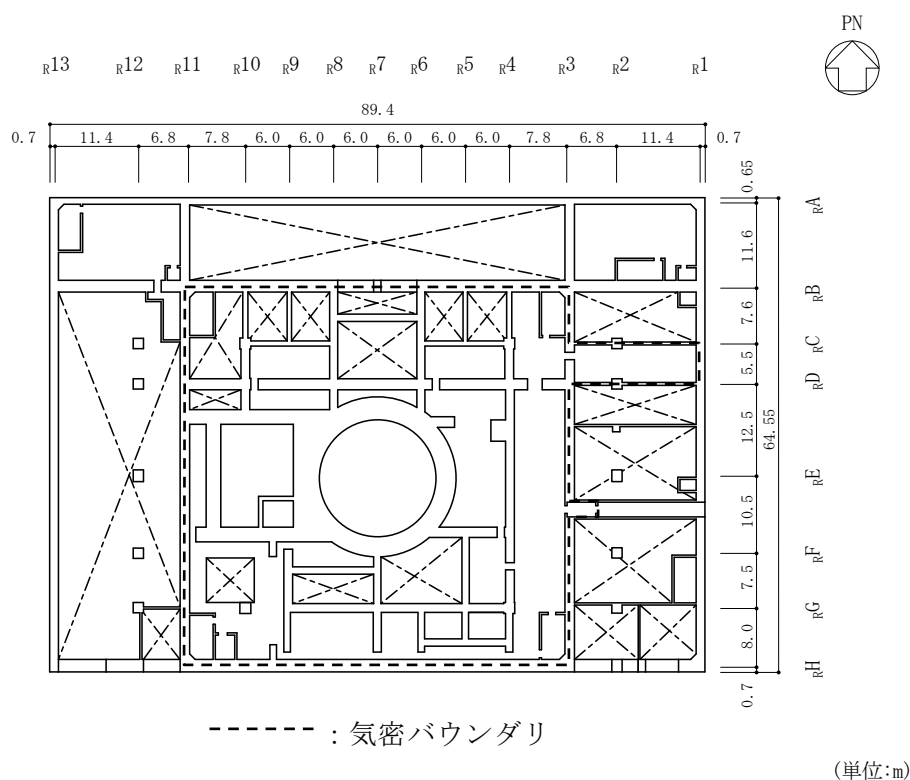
(5) 原子炉建物原子炉棟（二次格納施設）の概略平面図（EL 30.5m）
